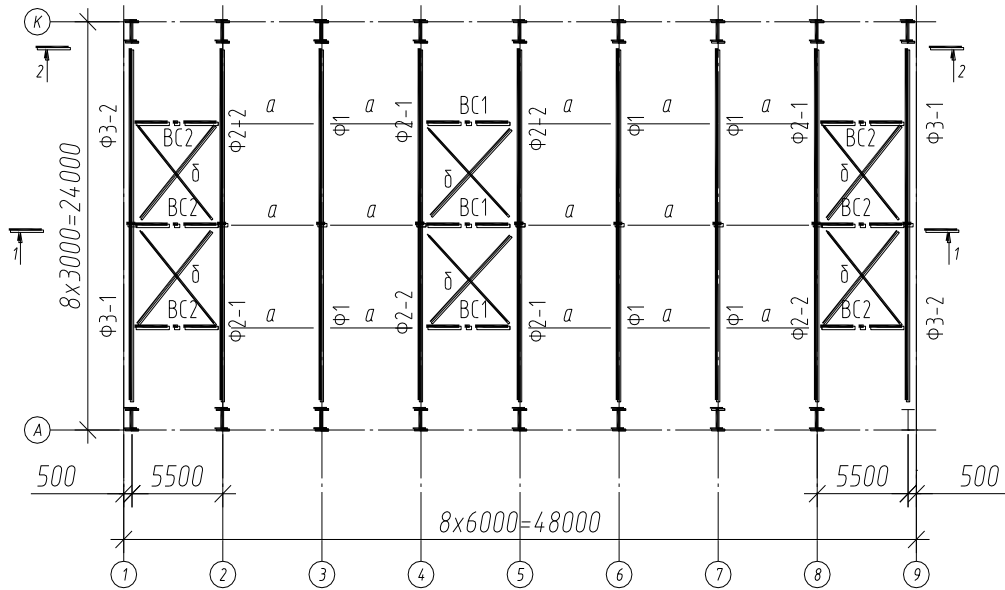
Схема расположения связей по нижним поясам ферм
